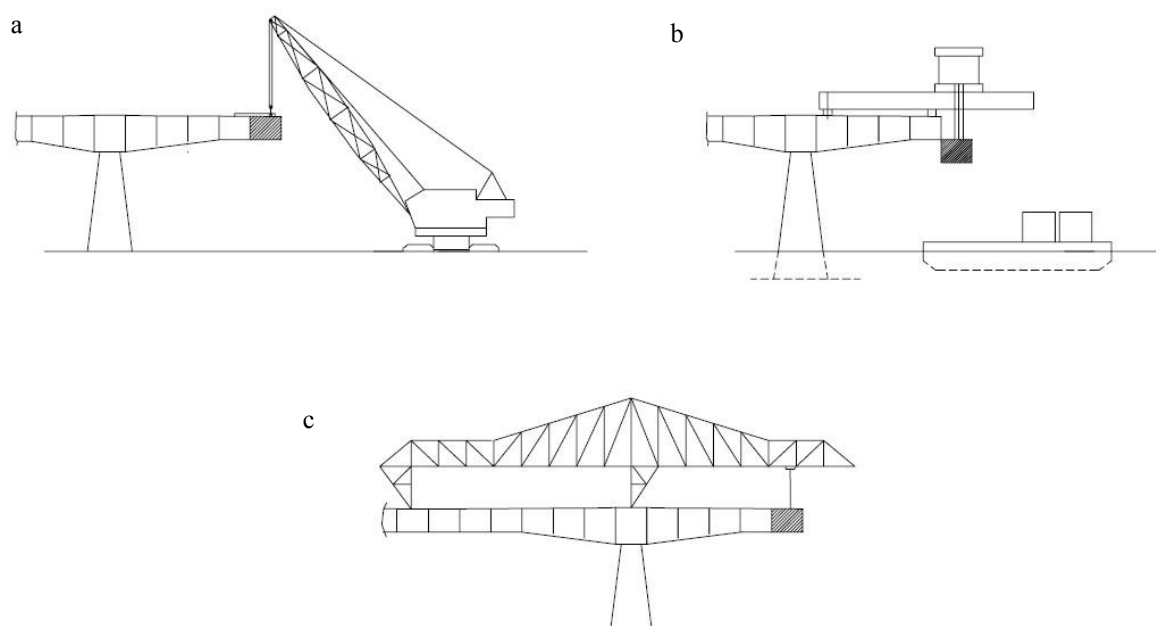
formas de montagem das aduelas pré-moldadas (a) guindaste; (b) ponte rolante e (c) treliça de lançamento (MATTOS, 2009)
